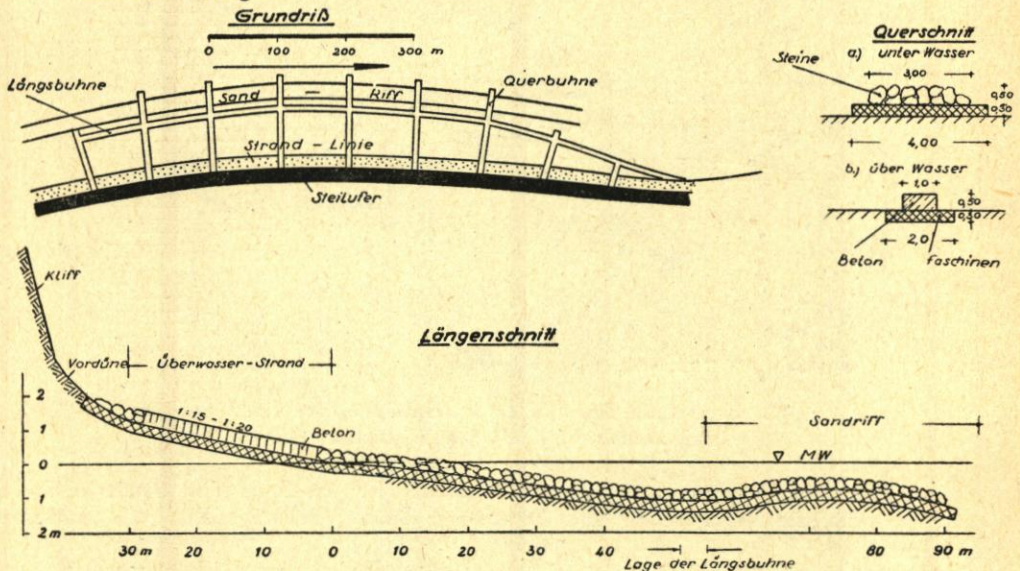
Prinzip-Skizze für flächenhaften Uferschutz
